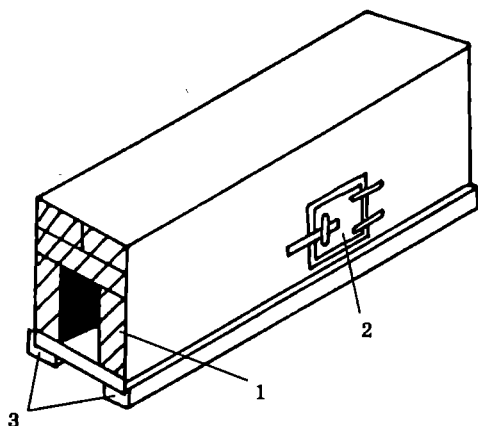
Шаблон (бук) для выкладки дымовых и вентиляционных каналов:
